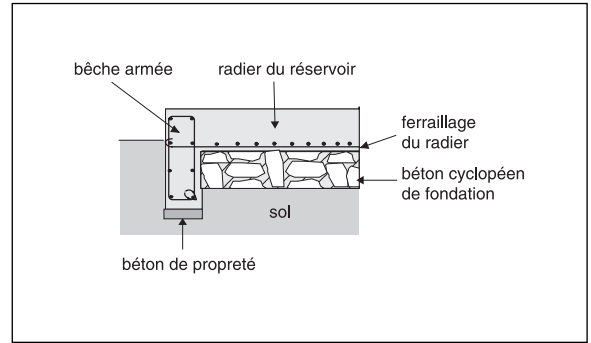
Exemple de fondation pour un réservoir de taille importante. Hauteur totale de la bèche (y compris épaisseur de la dalle) : 40 cm ; largeur de la bèche : 15 cm.
